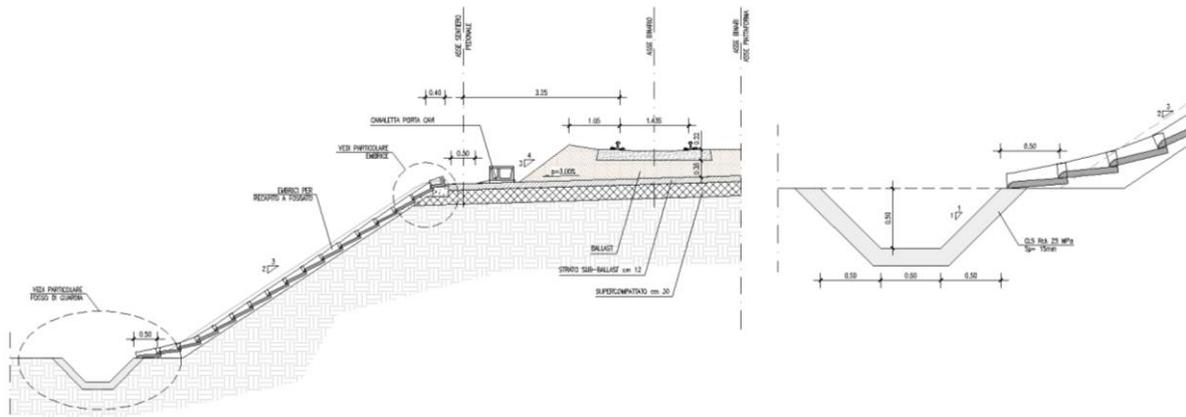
Schema di drenaggio acque di piattaforma in rilevato
